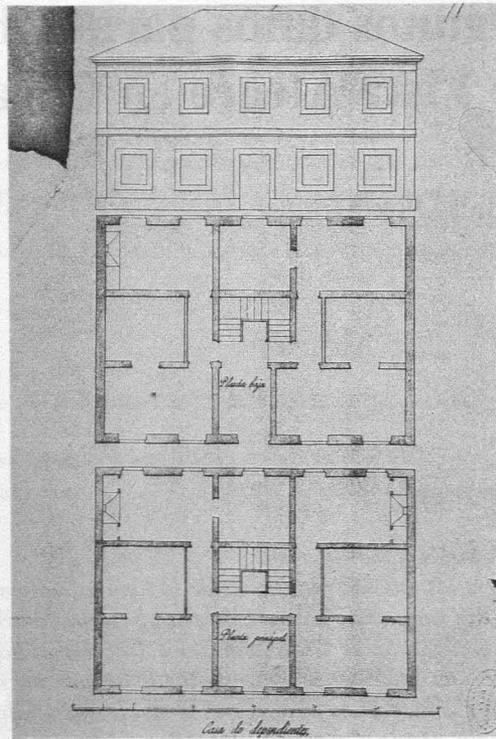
Alzado, planta baja y principal de la Casa de Dependientes (tinta y aguada en color, 440 por 315 mm. Escala: gráfica en pies castellanos). Sección planos, nº 3.514, A.G.P., Madrid.
